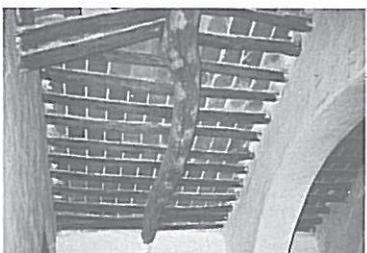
Pavimento com estrutura de madeira - Chagas.
